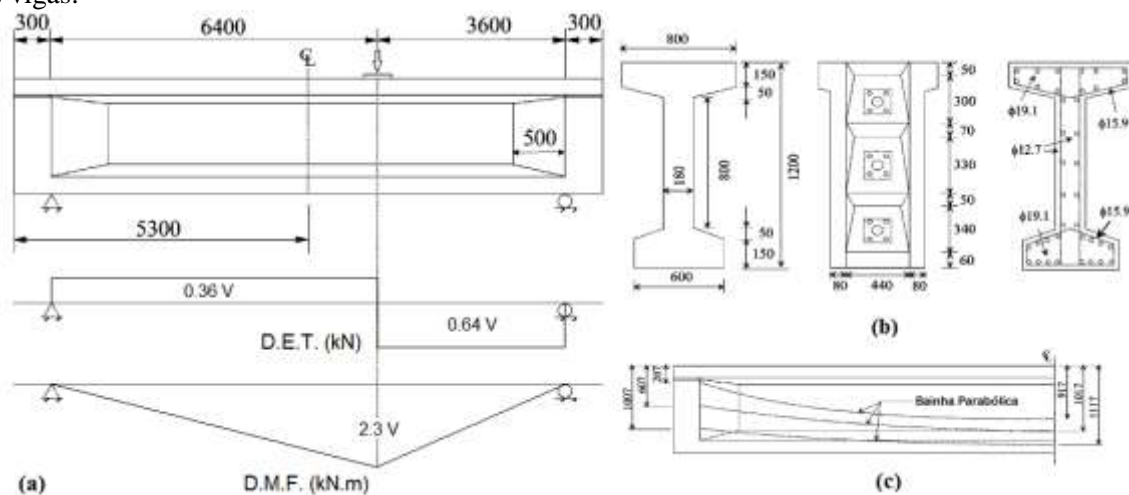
Características das vigas testadas por Oh e Kim: (a) Geometria e diagramas gerais de esforço transverso e momento flector; (b) Secções transversais a meio vão e na zona de ancoragem, e disposição das armaduras constituintes; (c) Disposição das bainhas de pré-esforço parabólicas [37].
